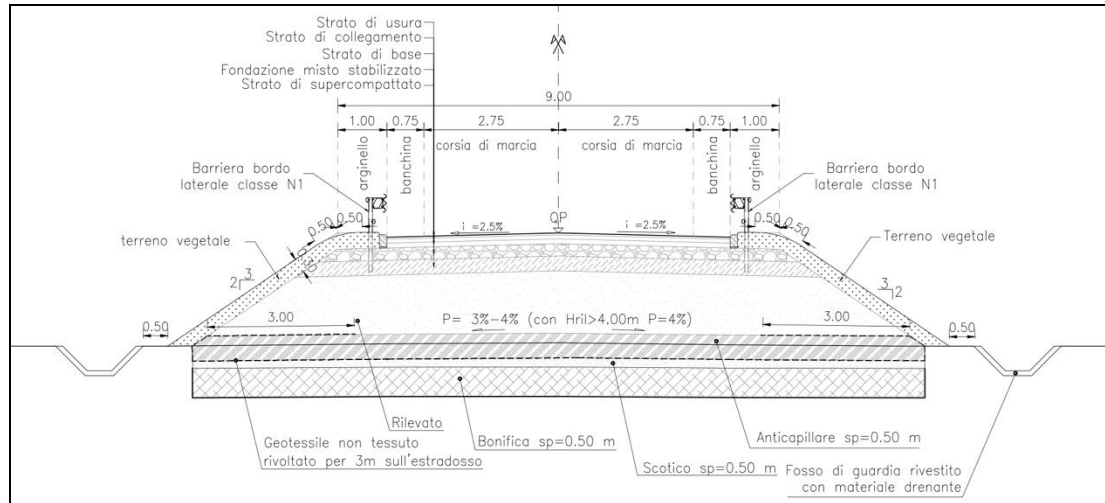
Sezione tipo in rilevato in prossimità dell'intersezione con via Burchè.
